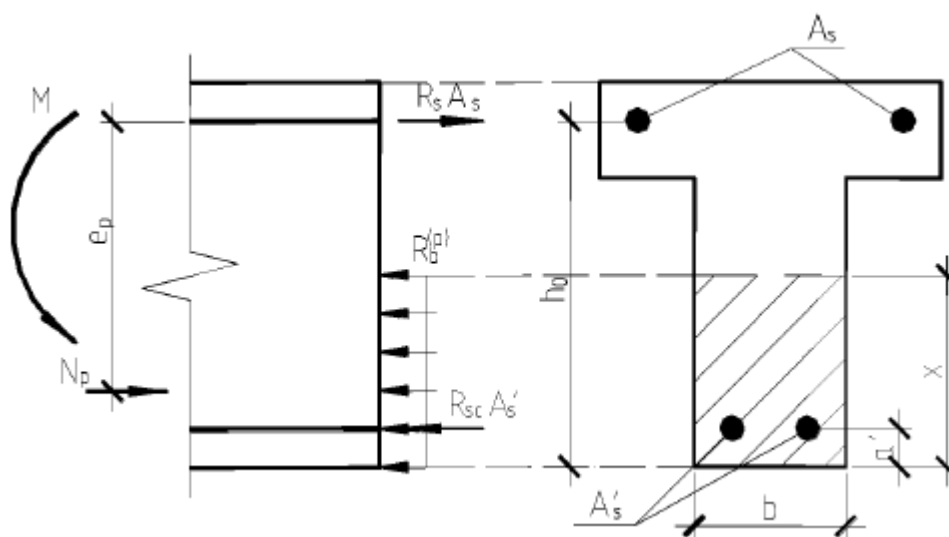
Схема усилий в поперечном сечении железобетонного элемента с прямоугольной сжатой зоной в стадии предварительного обжатия
